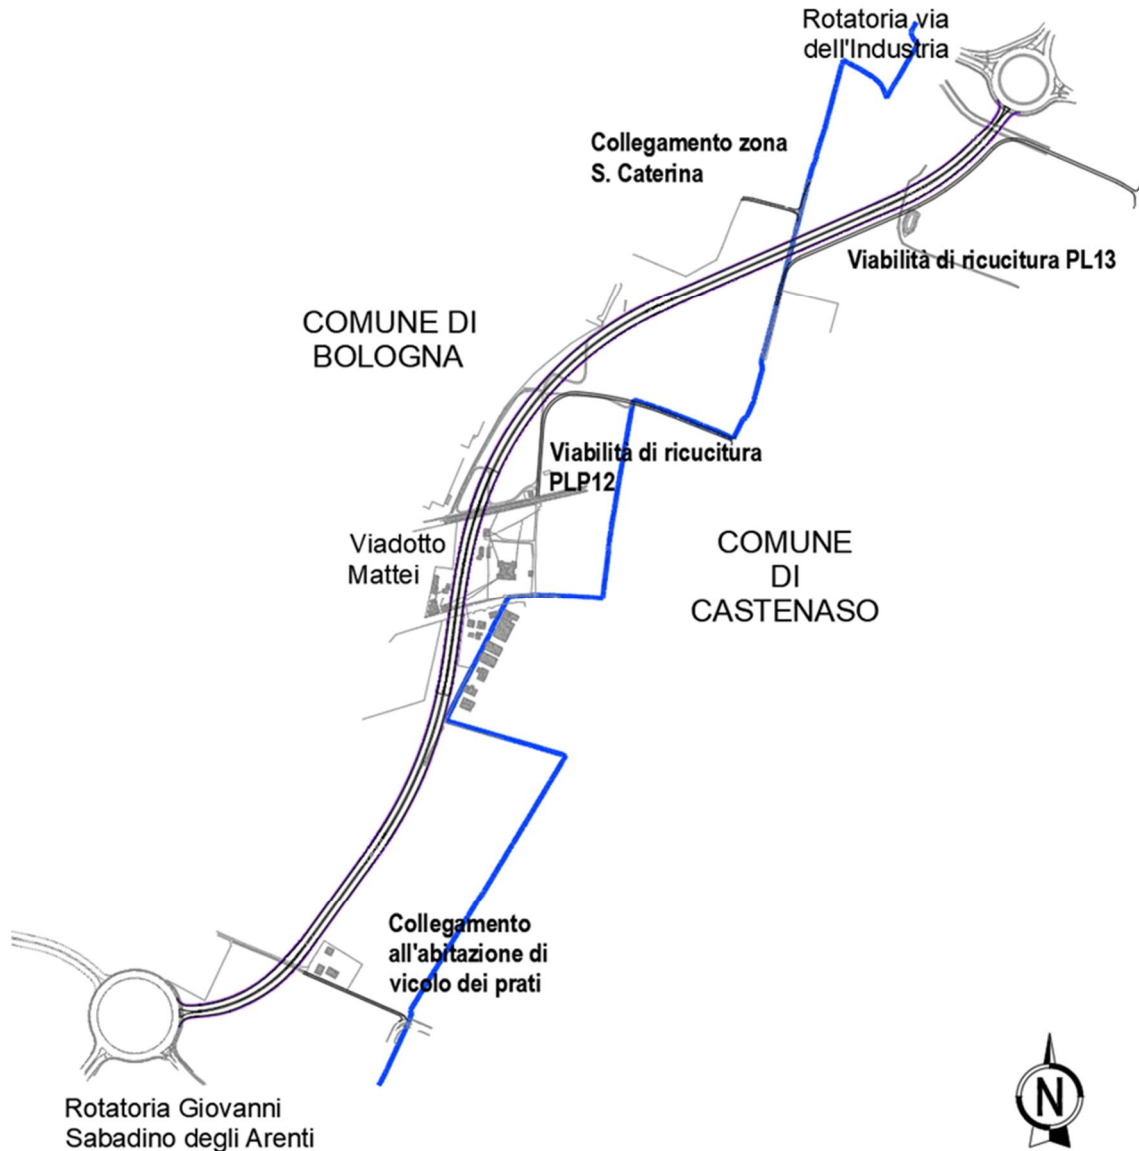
Planimetria schematica della strada Lungo Savena III lotto.
